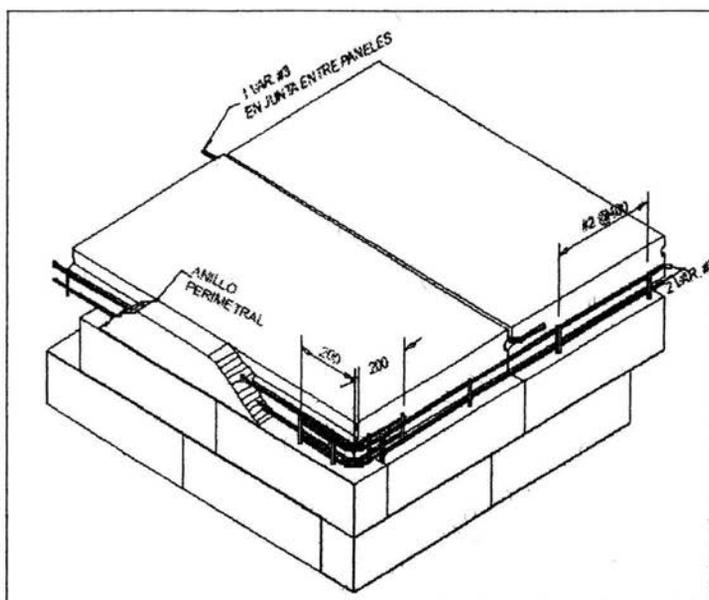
En la figura se observa un ejemplo de armado de anillo perimetral, compuesto de 2 varillas de 3/8 " de diámetro y el armado de las juntas longitudinales que con una varilla de 3/8" de diámetro.
